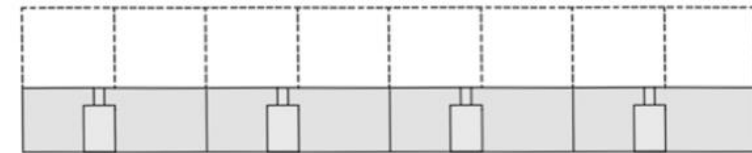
Esquema planta segunda. Fuente: Elaboración propia
